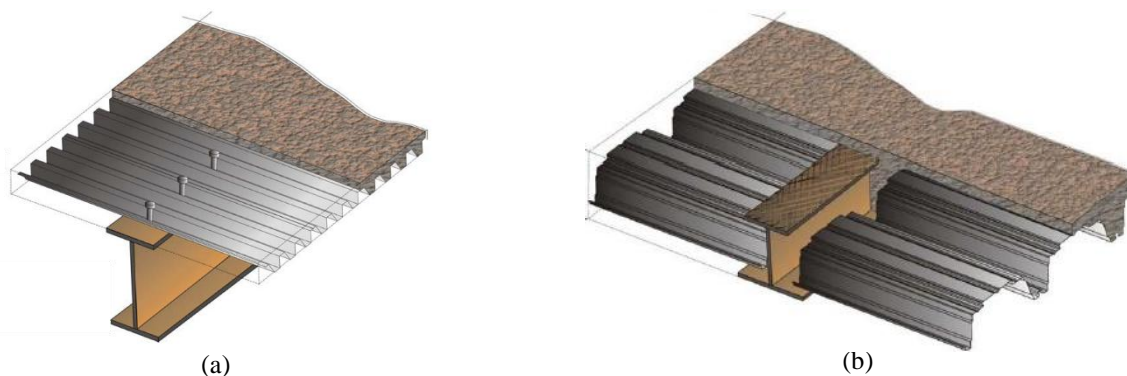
Viga do sistema de piso do tipo *slim floor* (PAES, 2003).
